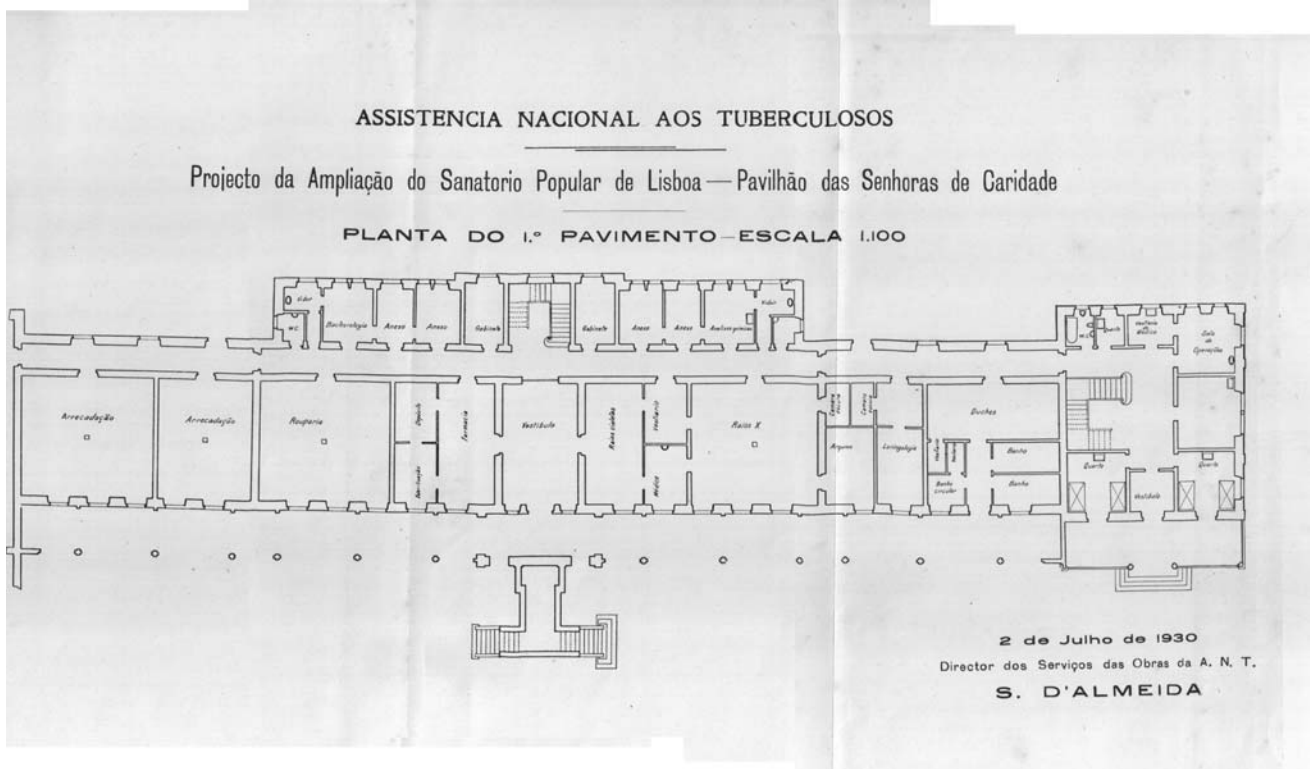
Planta do 1º. Pavimento. DGCH, s/r.
